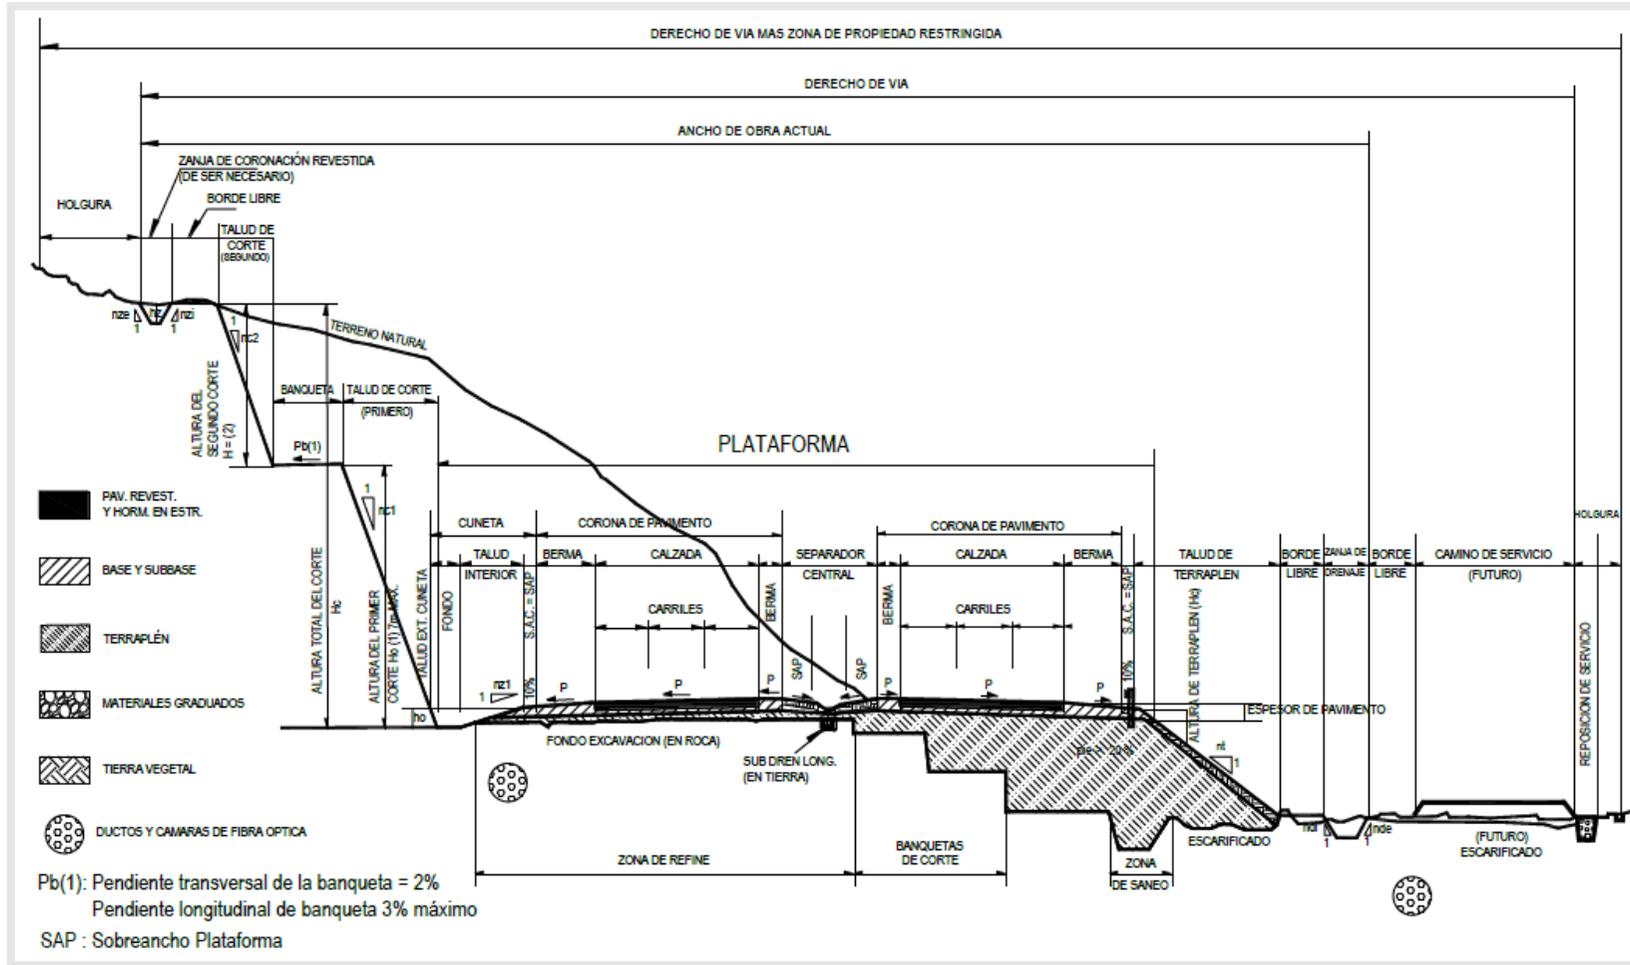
Sección transversal tipo a media ladera para una autopista en tangente
